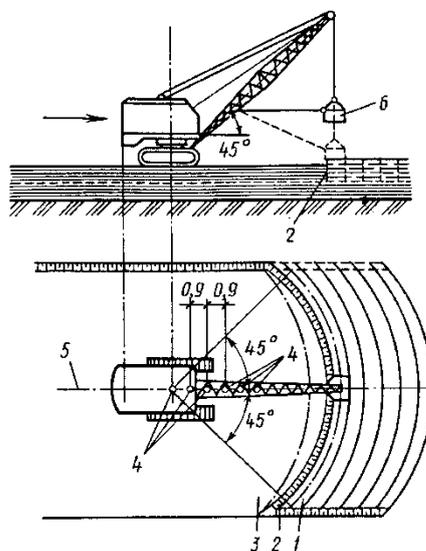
Схема поверхностного уплотнения грунта тяжелой трамбовкой.
